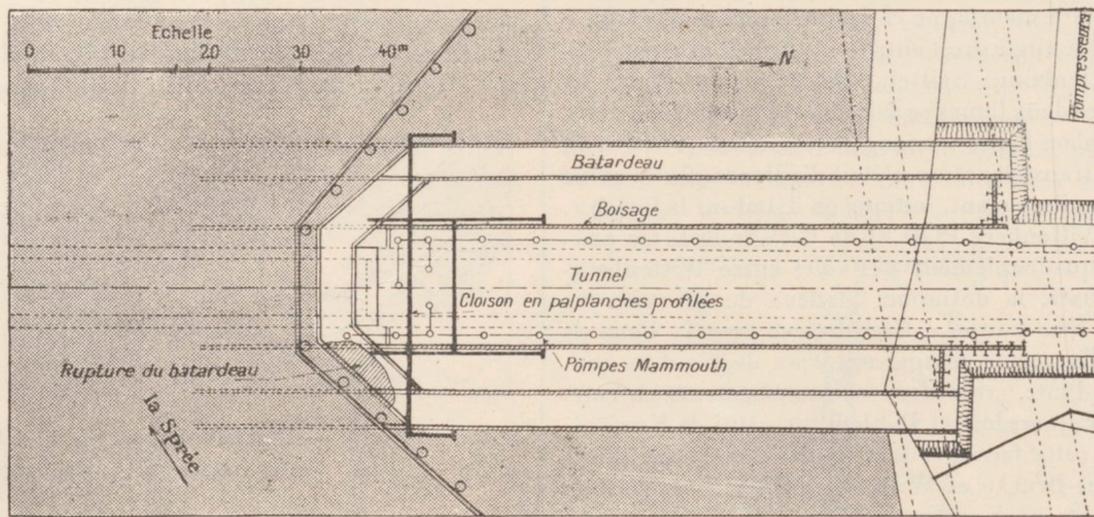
Plan du chantier nord du tunnel (rive droite de la Sprée).
